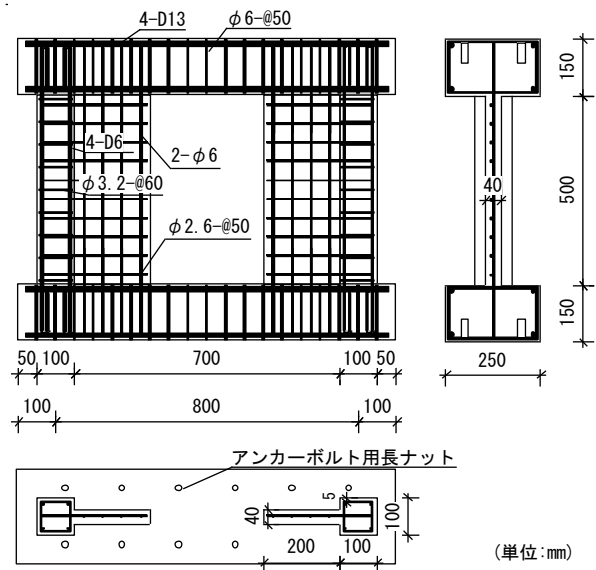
試験体寸法および配筋図の例 (袖壁長さ 200mm)
